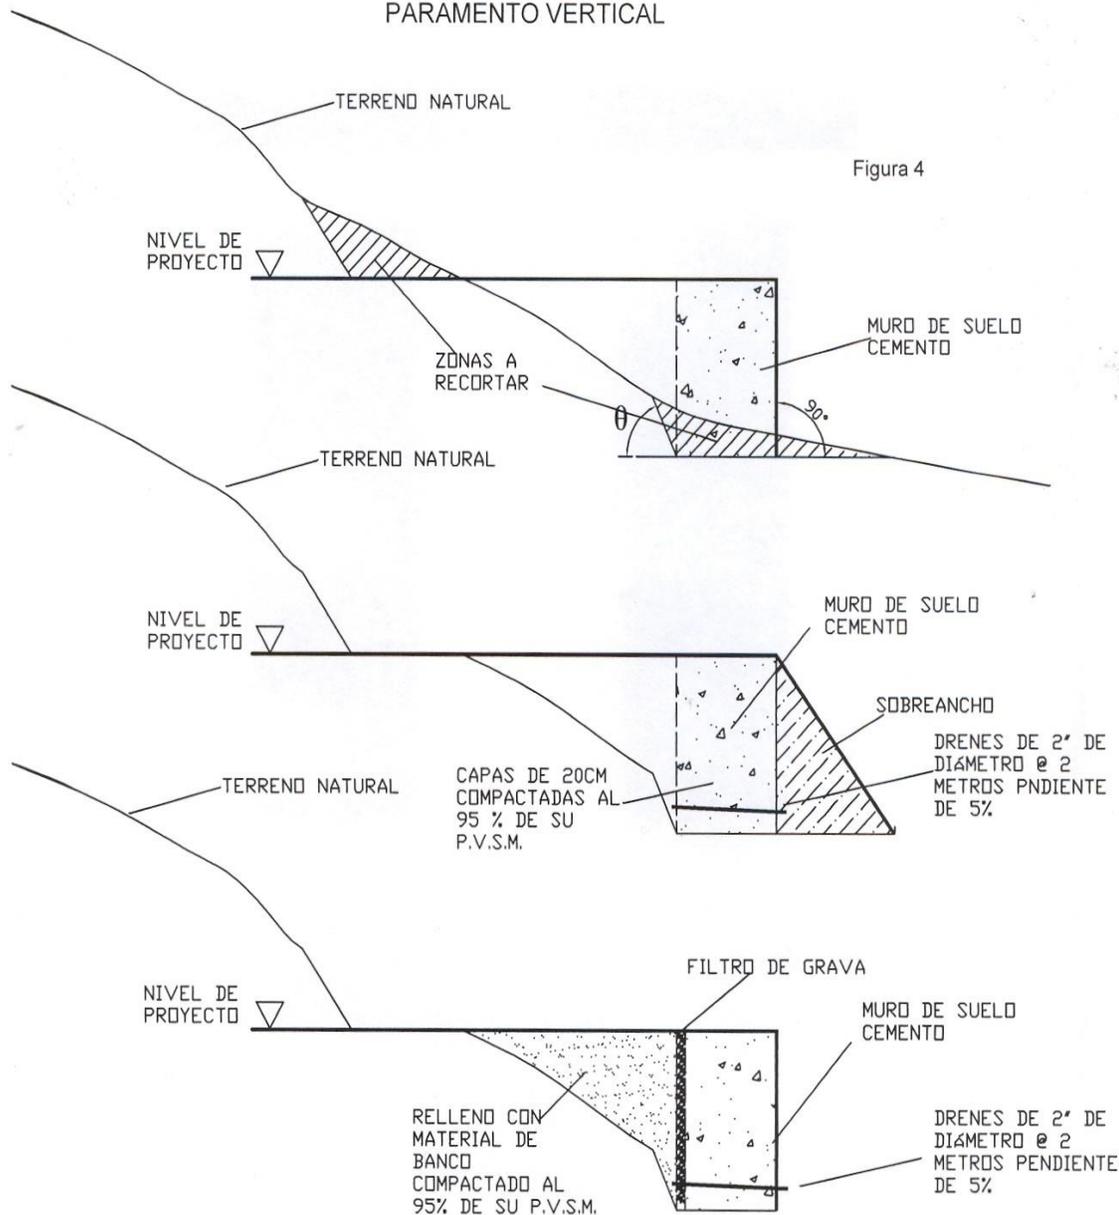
MURO DE SUELO CEMENTO COMPACTADO CON PARAMENTO VERTICAL
